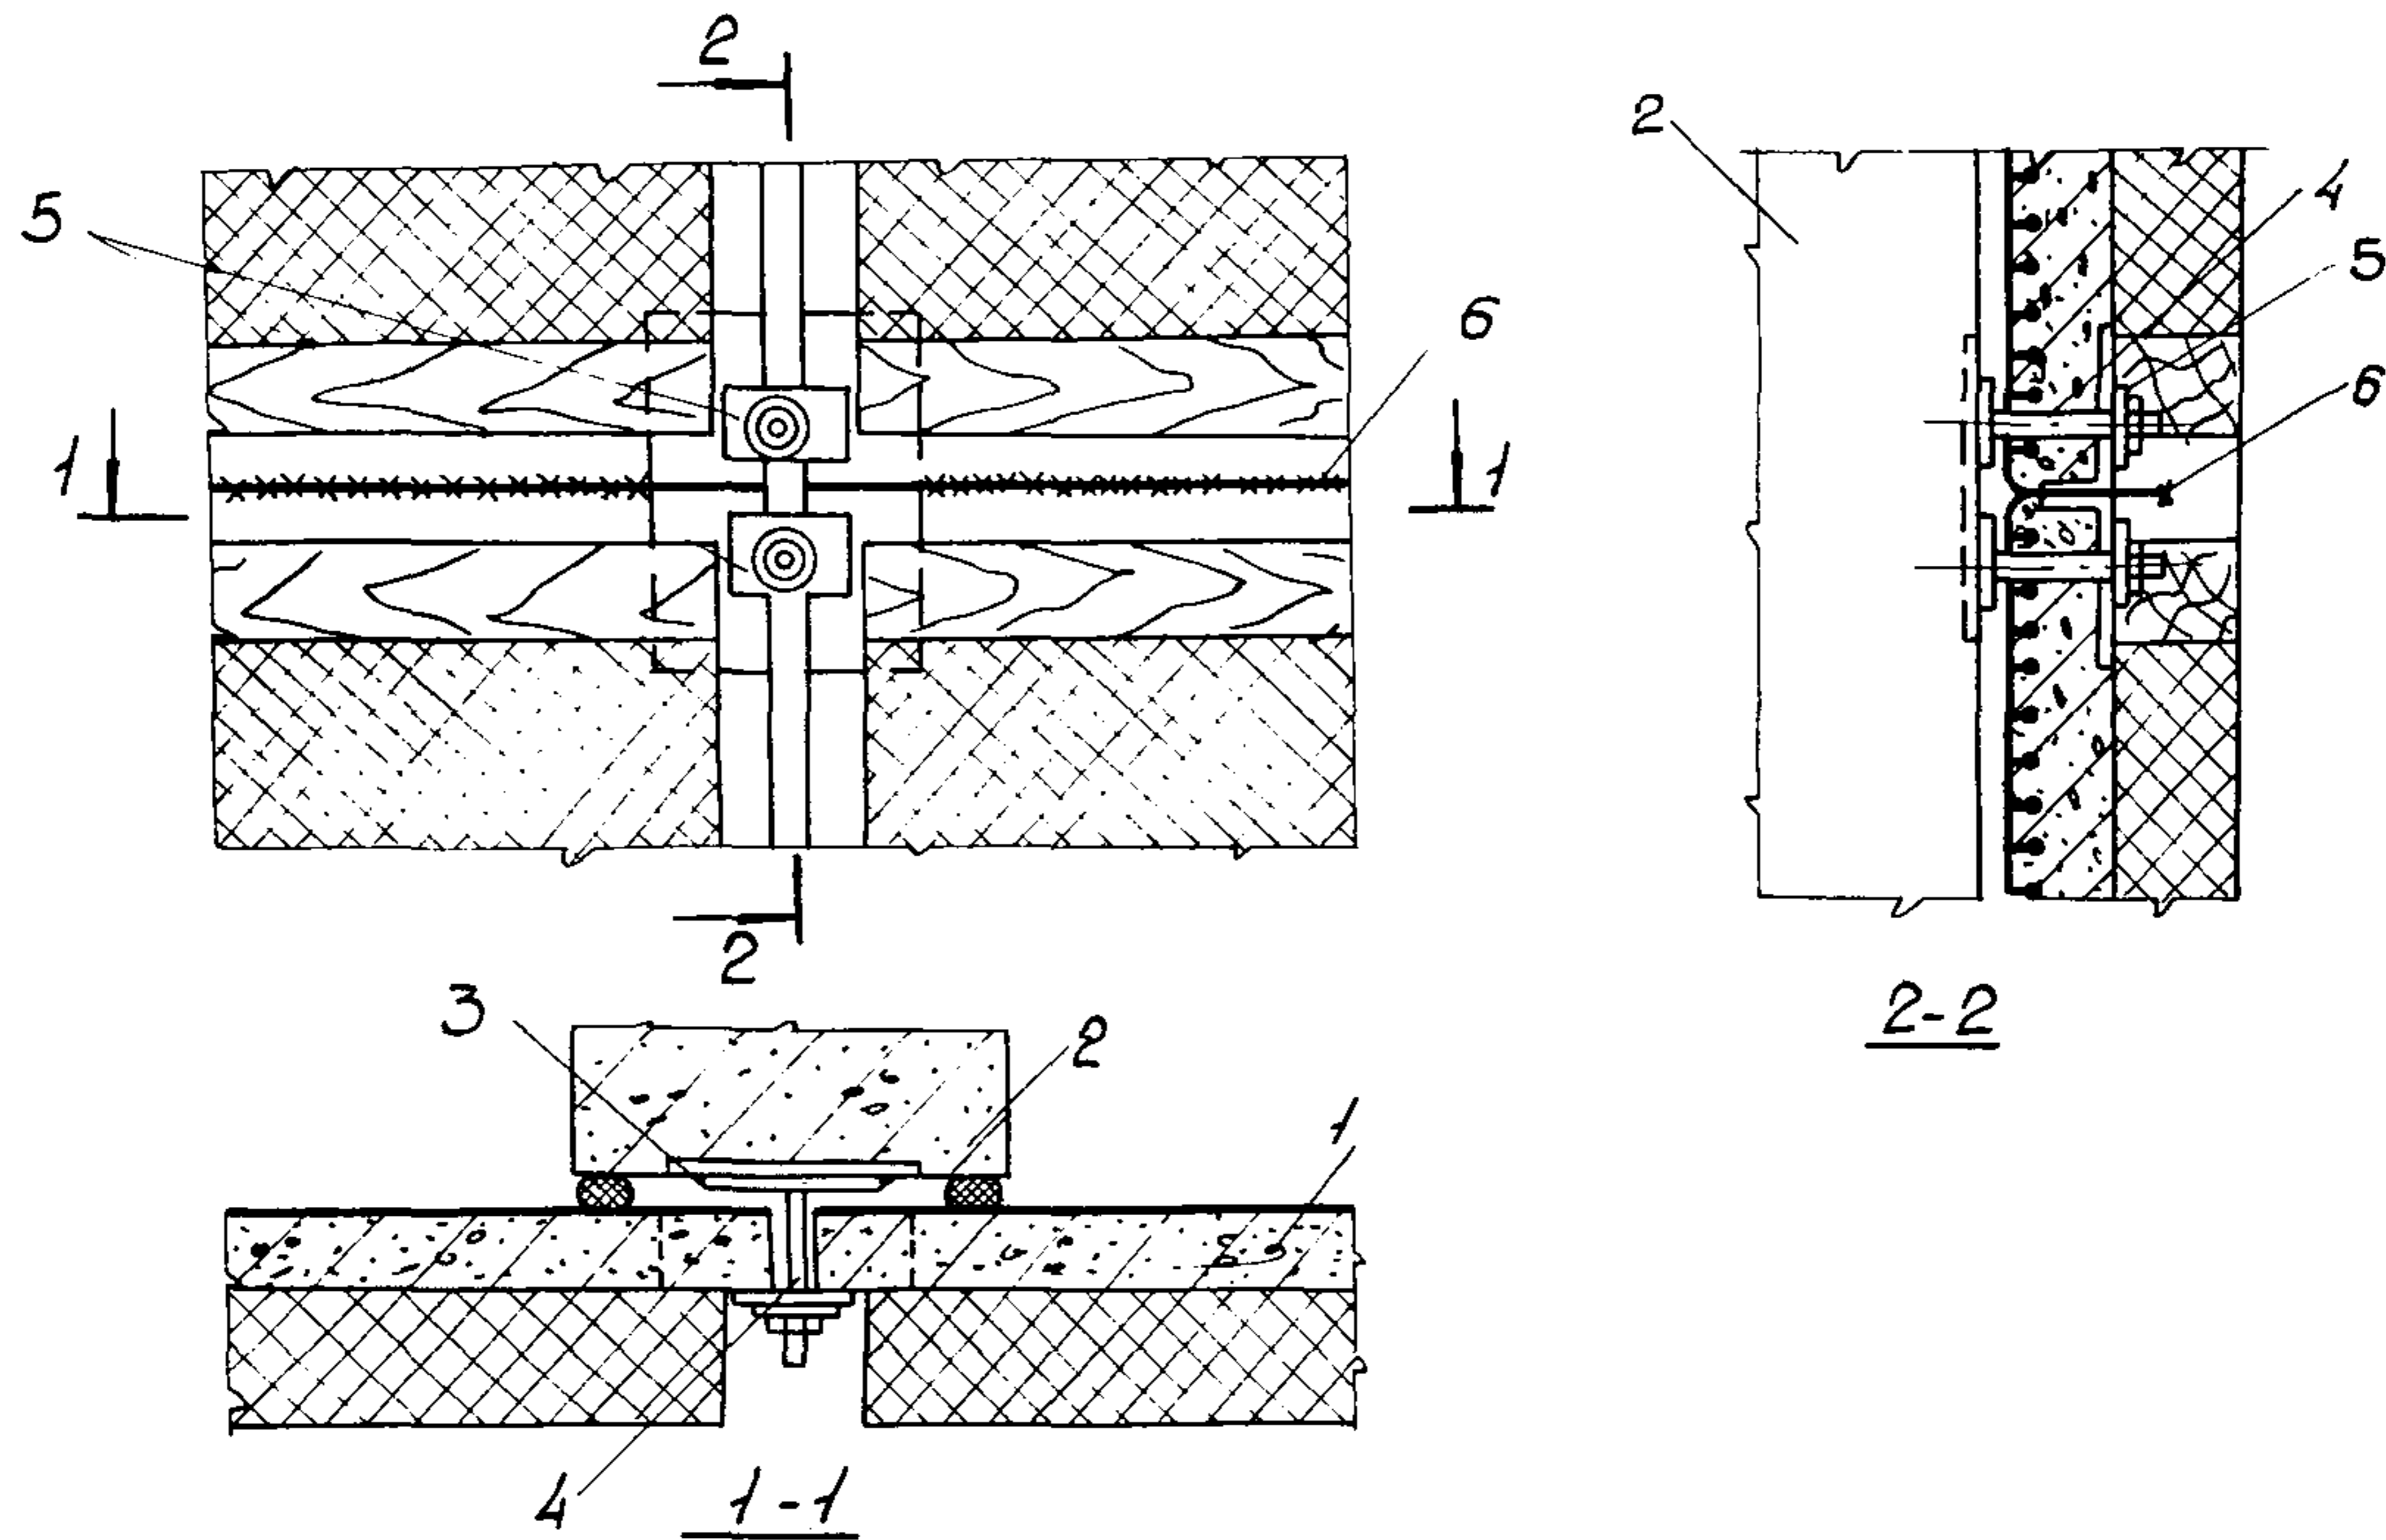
Рис. II. Узел крепления трехслойных панелей с полиэтиленовым покрытием к колонне
